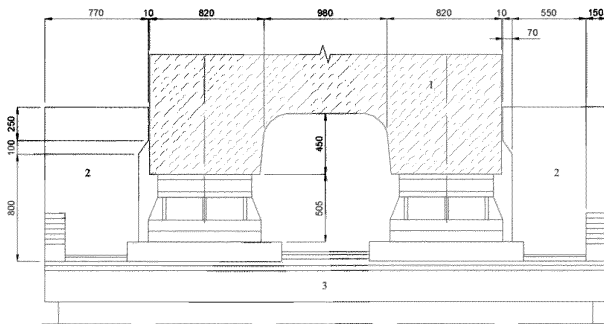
Стопоры, защищающие от поперечного сдвига пролетные строения длиной 23,6 и 27,6 м: 1 – пролетное строение; 2 – железобетонный стопор; 3 – устой
